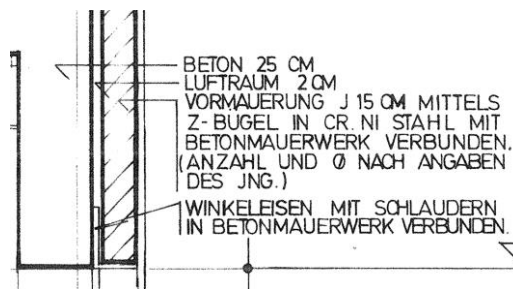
Ausschnitt Plan Nr. 147/111, Turnhalle Garderobe, Schnitte 40-46, E. Ulrich 1971
